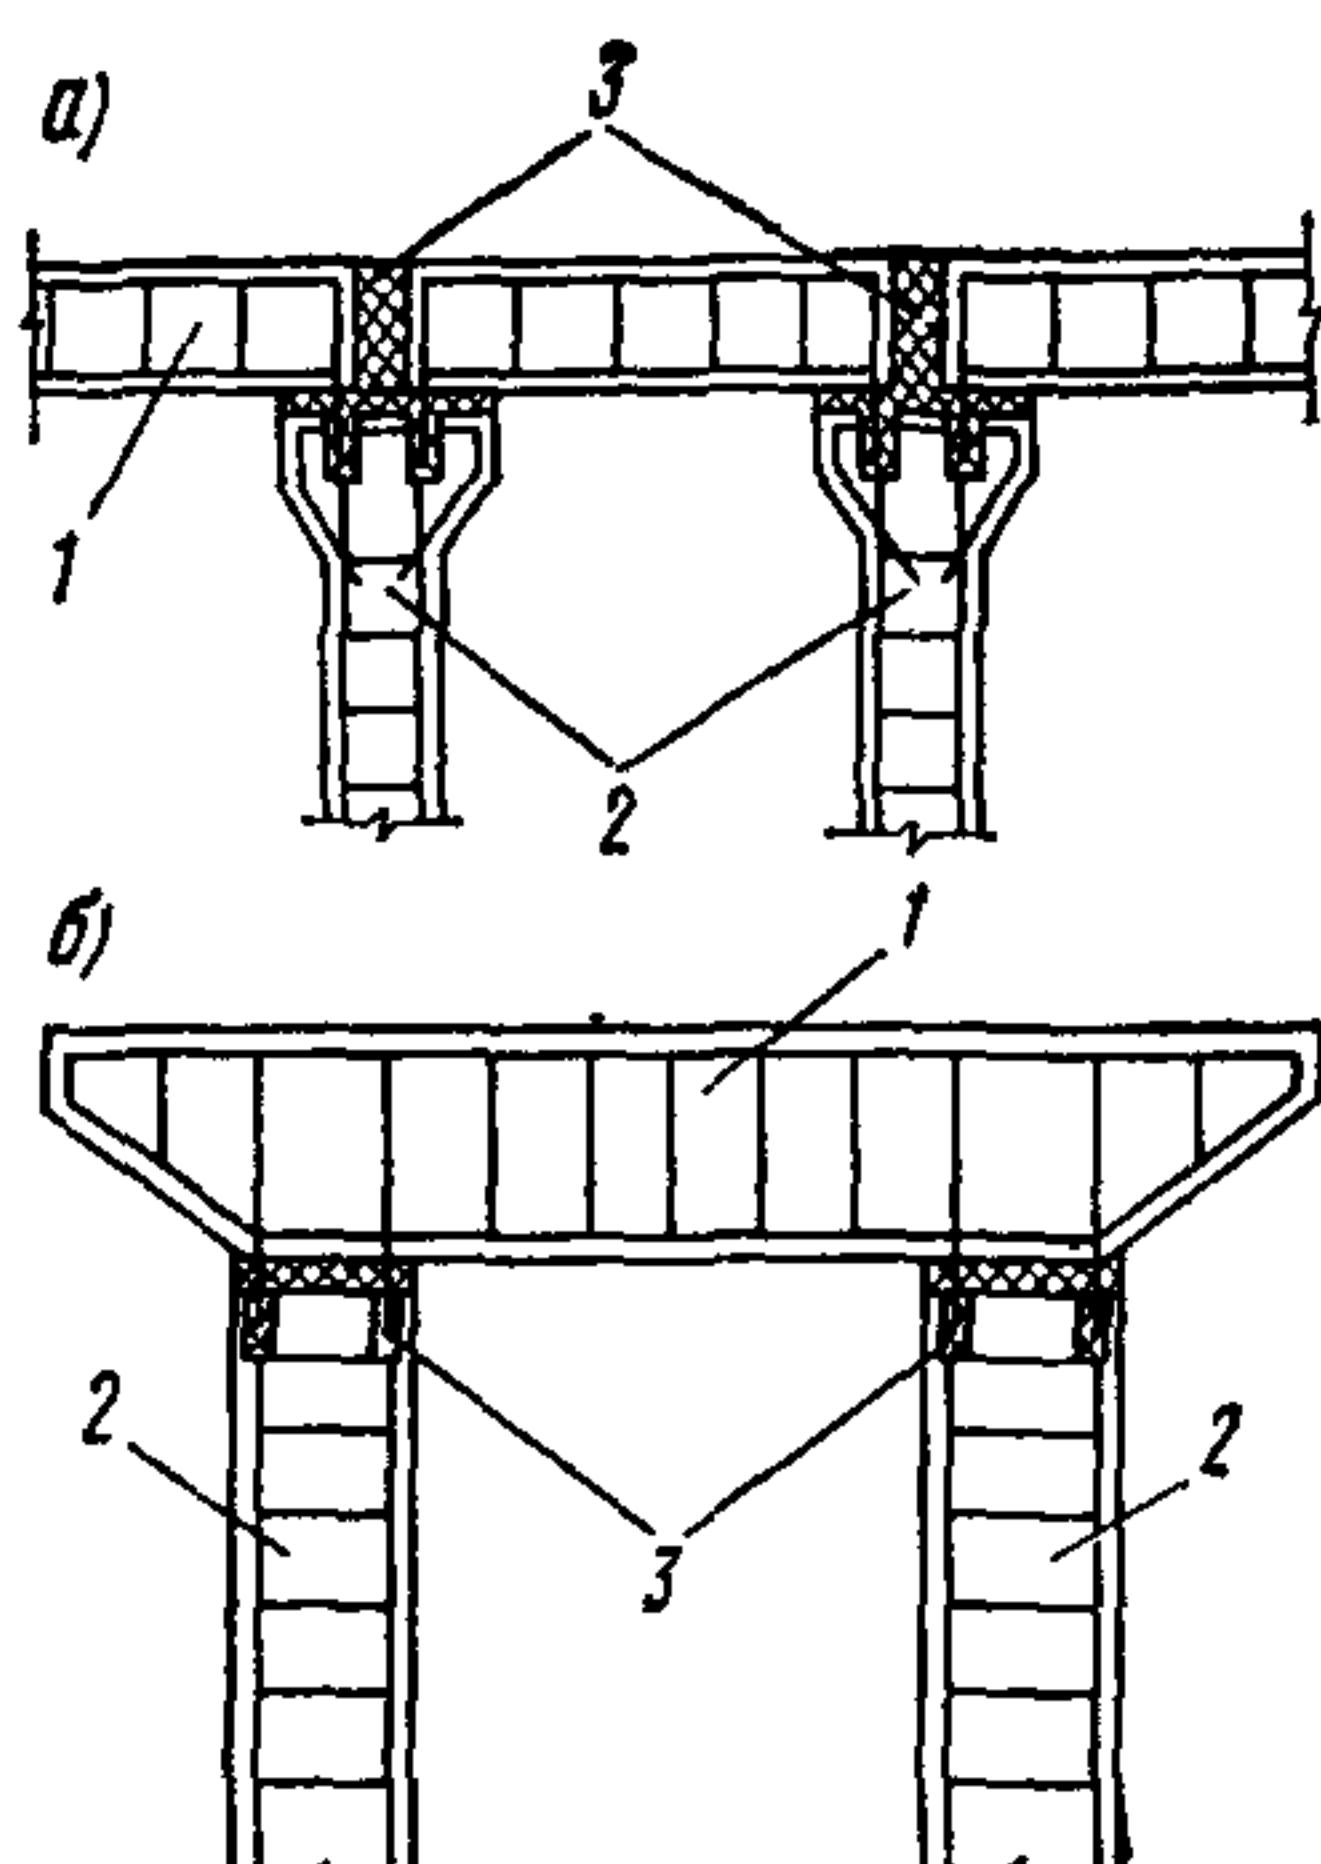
Примеры kleевых соединений железобетонных конструкций подвальных эстакад с разрезкой конструкций
